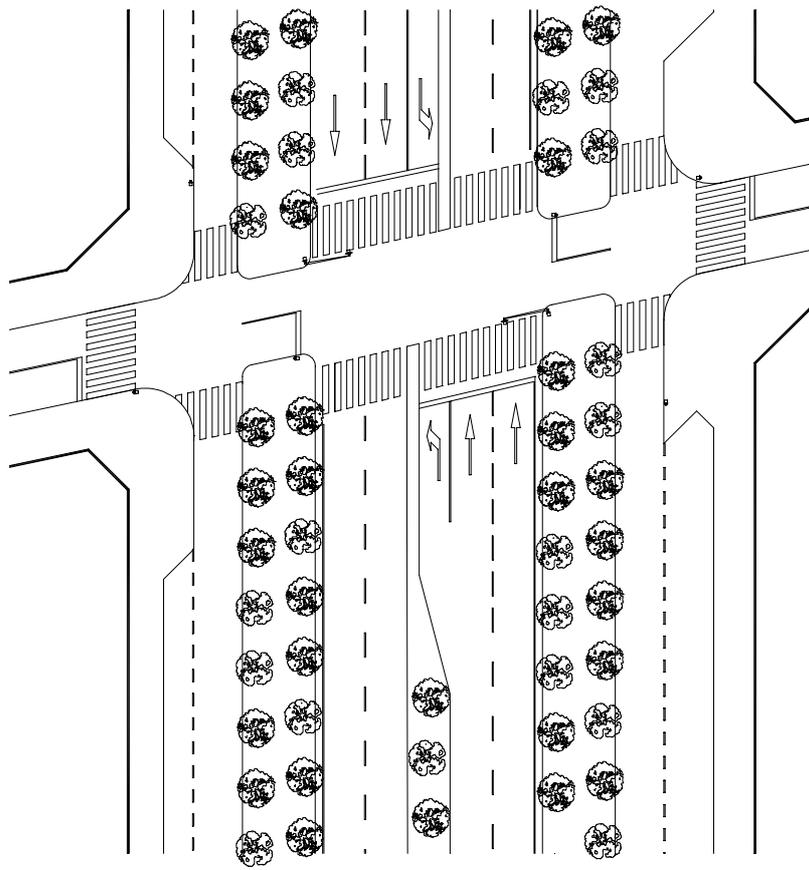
EJEMPLO DE DISEÑO EN PLANTA DE UN BULEVAR DE ANDENES LATERALES (Fuente: Jacobs, B. 1995)
